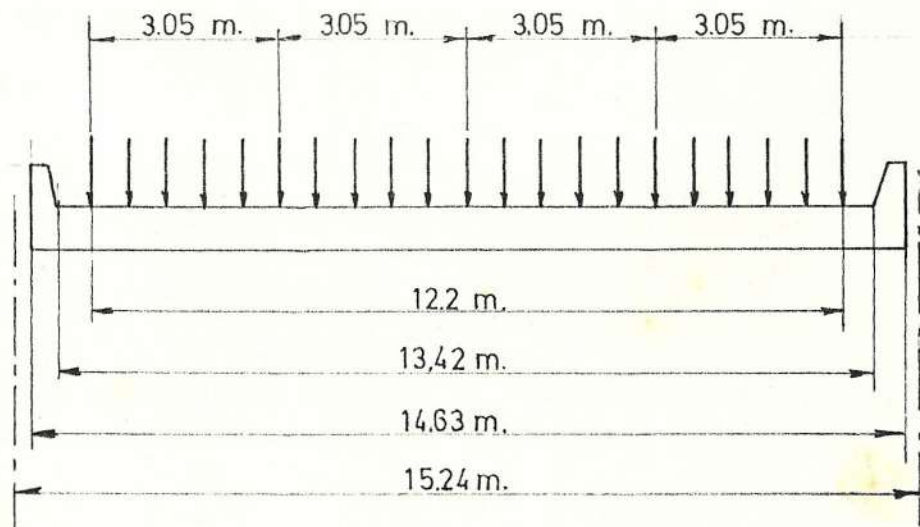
DISTRIBUCION DE CARGAS NORMALIZADAS SOBRE EL ANCHO DE CALZADA.
